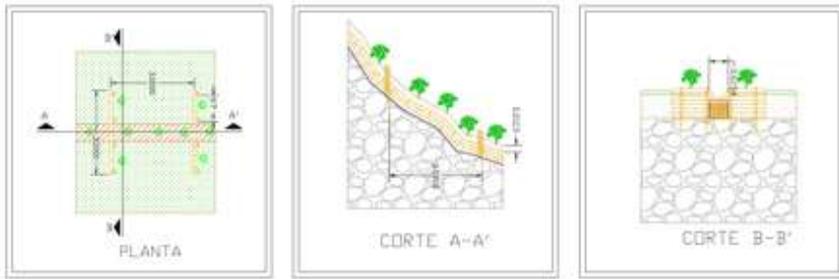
Detalles constructivos de filtro vivo y trincho dissipador.
